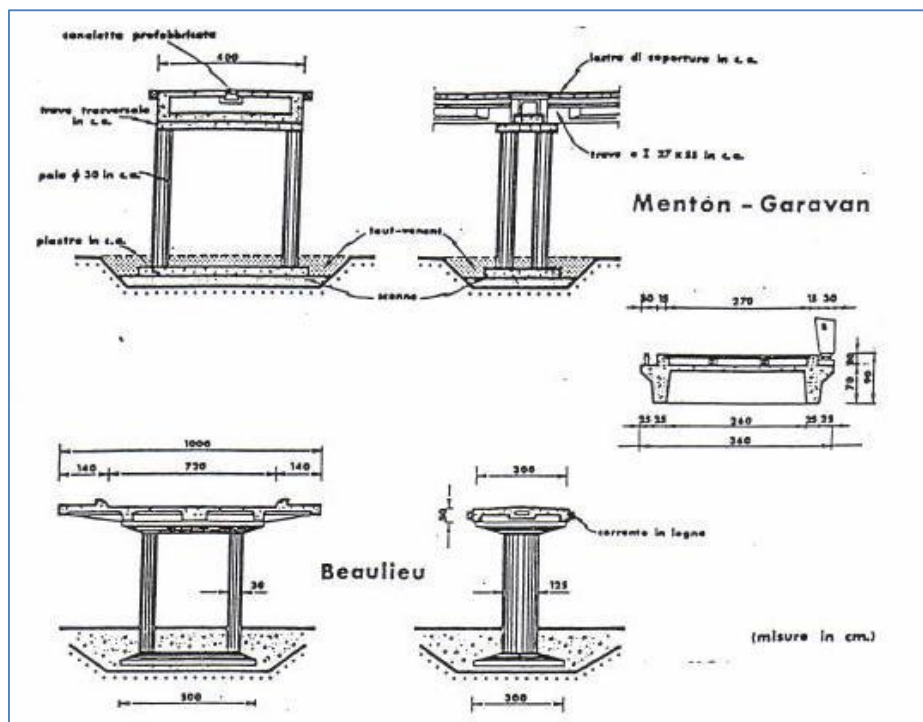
Pantalán de hormigón con pilas de gravedad
